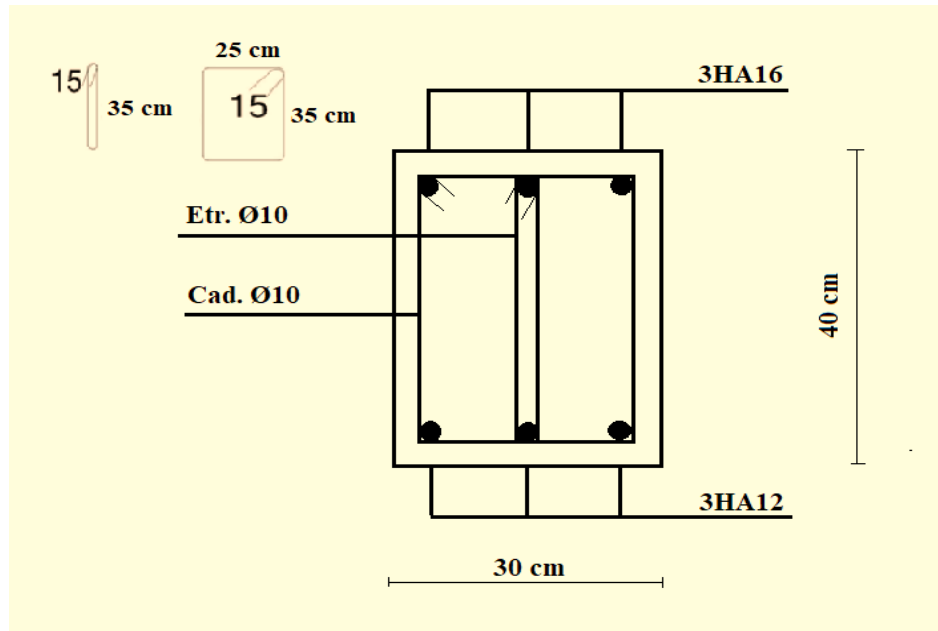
Ferrailage des poutres secondaire au niveau de la travée pour 2^{ème} ; 1^{ère} étage et RDC.
